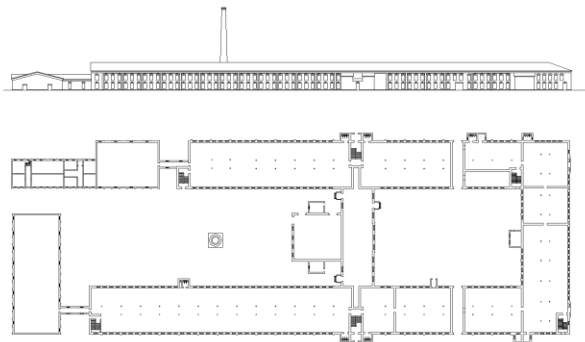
Фасад и план льнопрядильной фабрики «Двина» [19]
